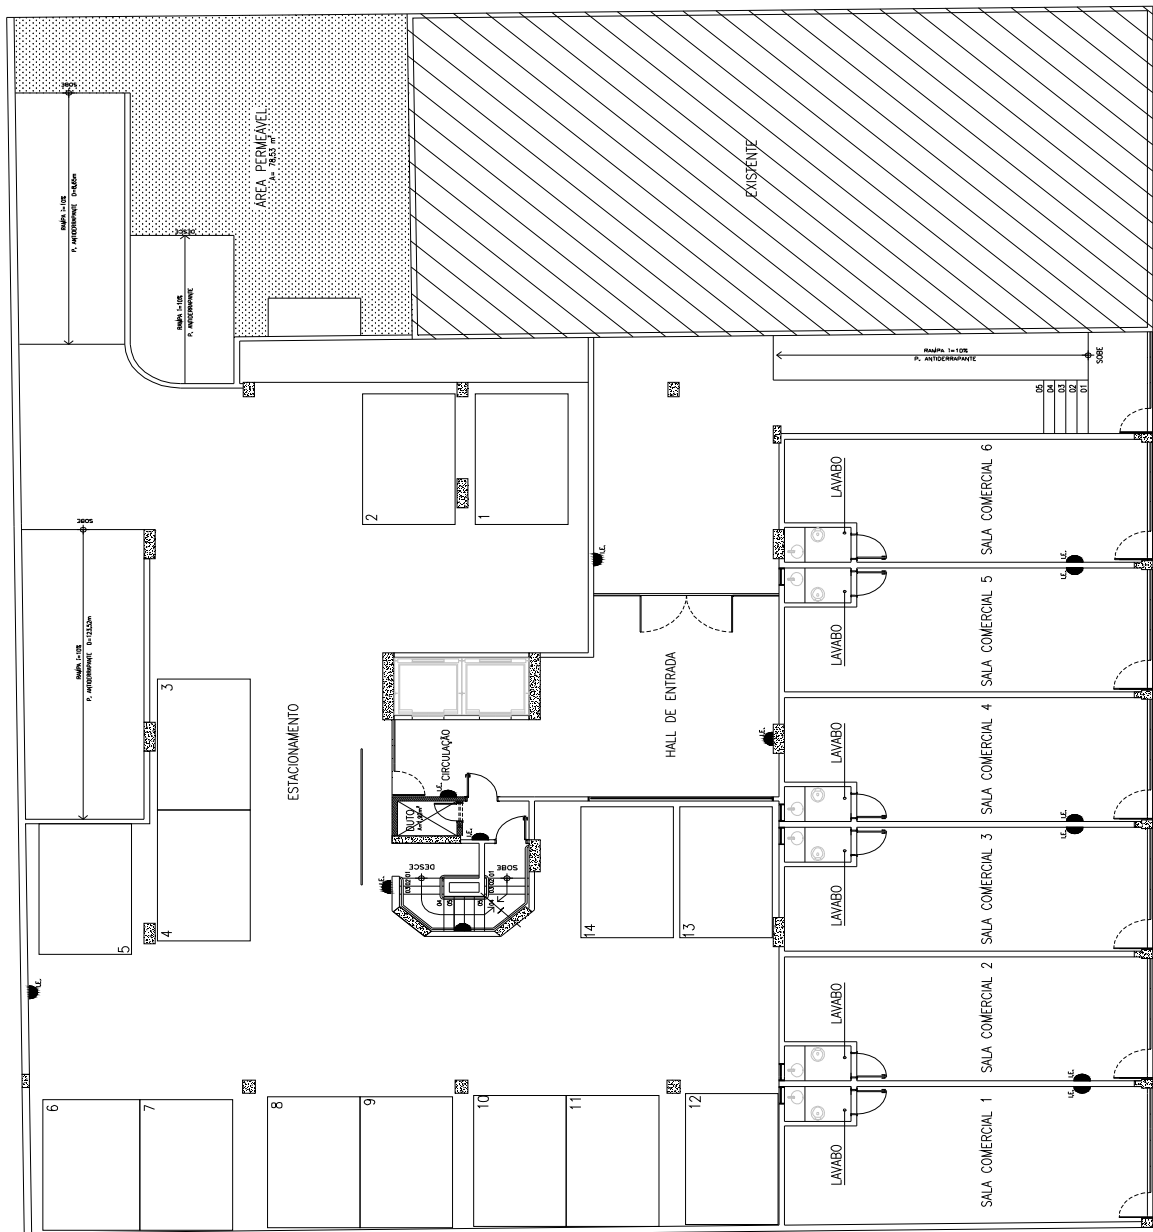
Planta baixa do pavimento térreo – Obra A
